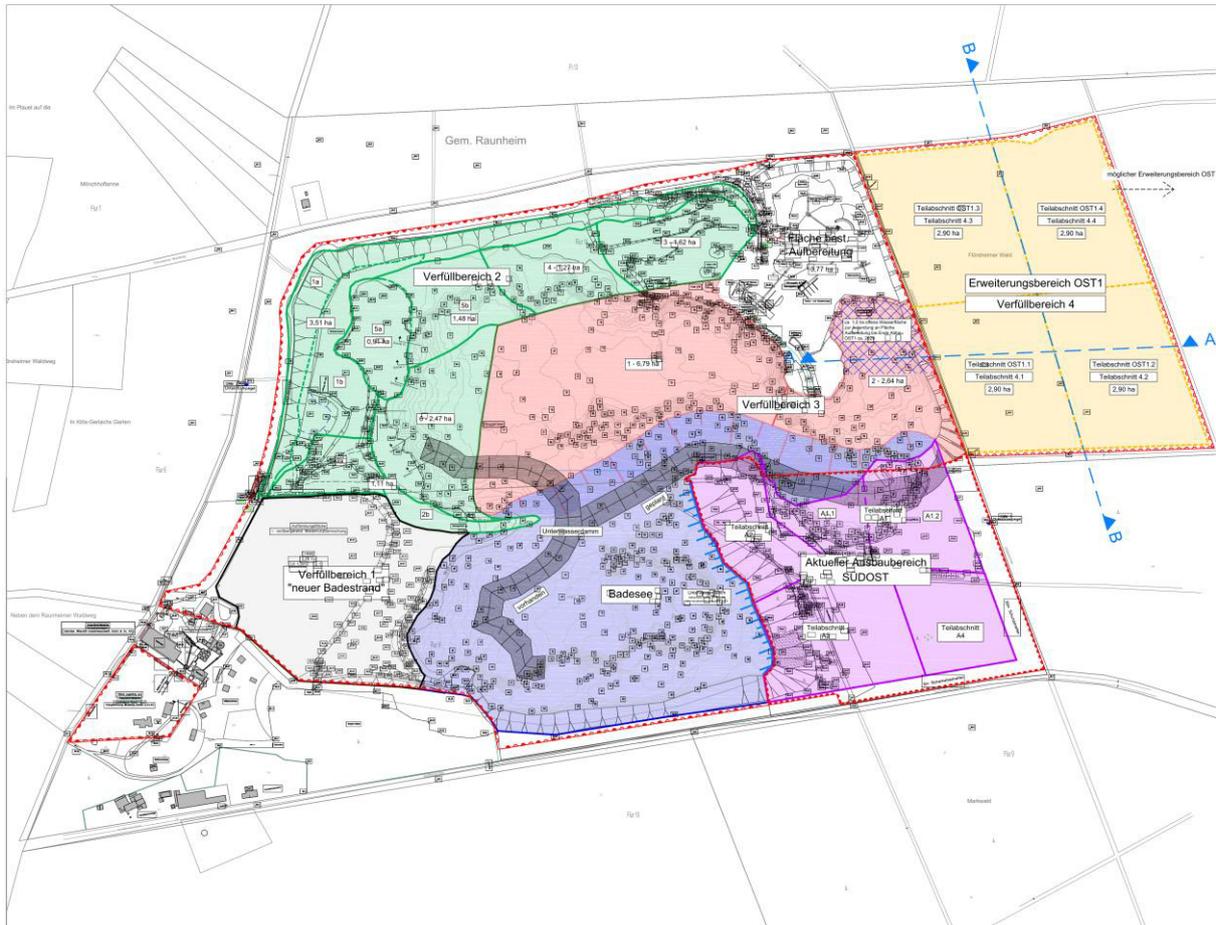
Lageplan Tagebau Raunheim [U 1.1]
